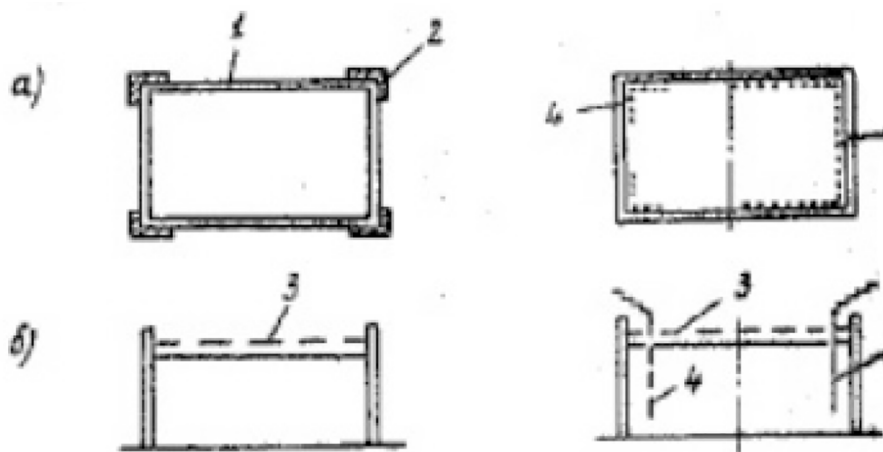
Дополнительные мероприятия по утеплению блоков методом «термоса»: а – планы; б – разрезы; 1 – теплая опалубка; 2 – утепление углов; 3 – укрытие; 4 – электрообогрев углов [7]
